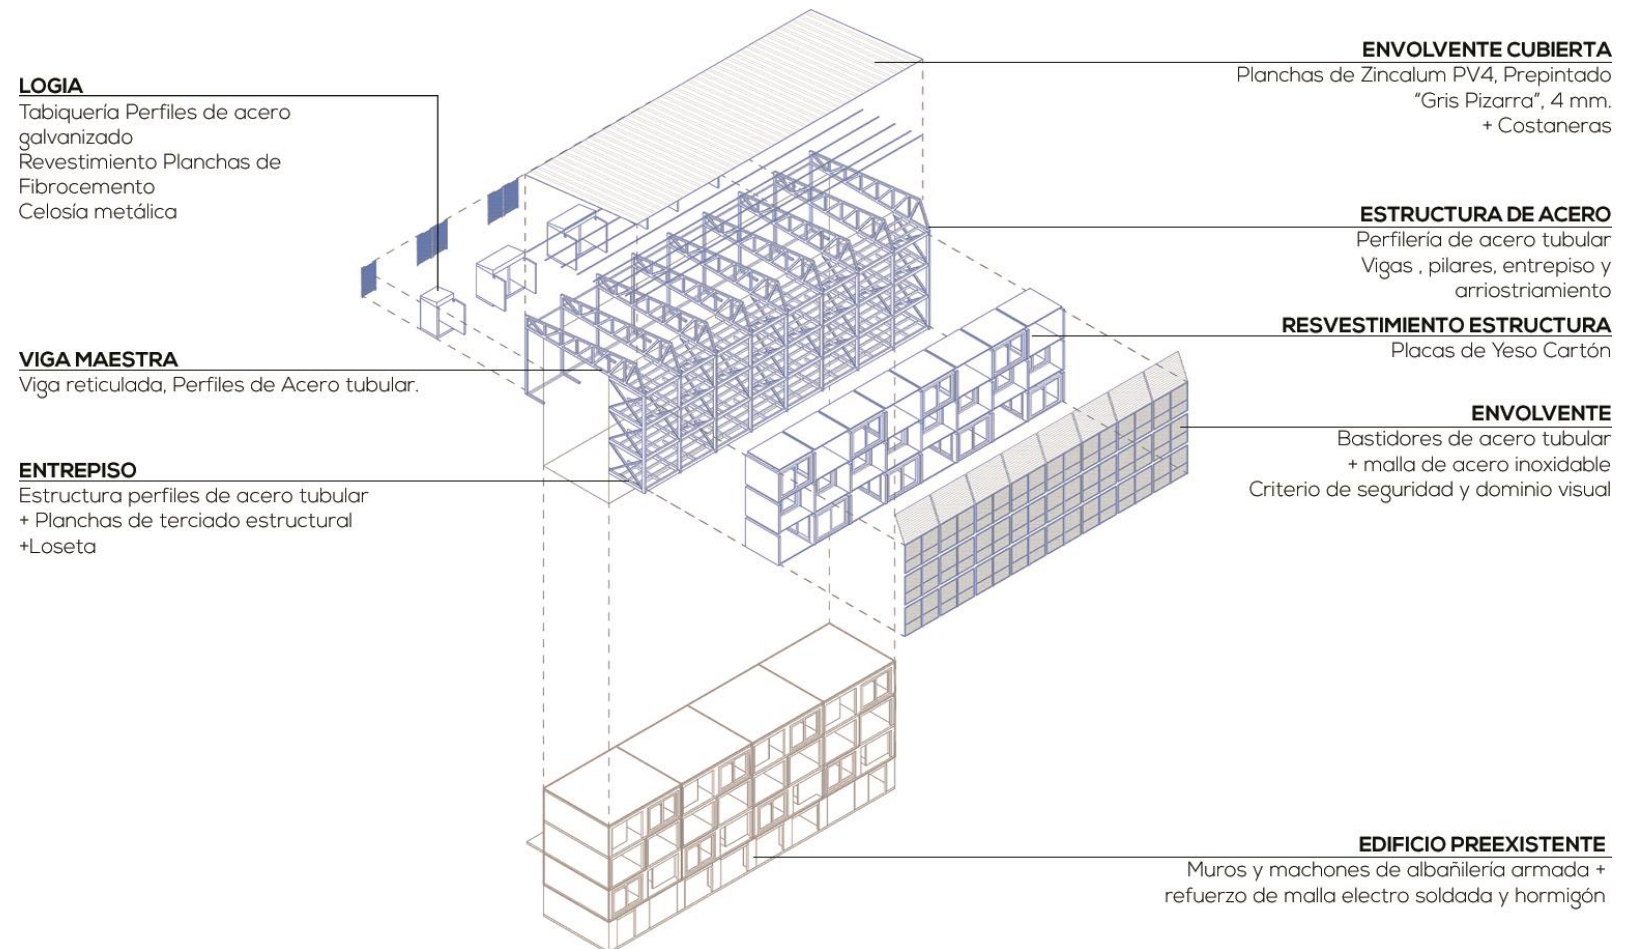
Esquema de Sistema Constructivo. Fuente: Elaboración propia.
